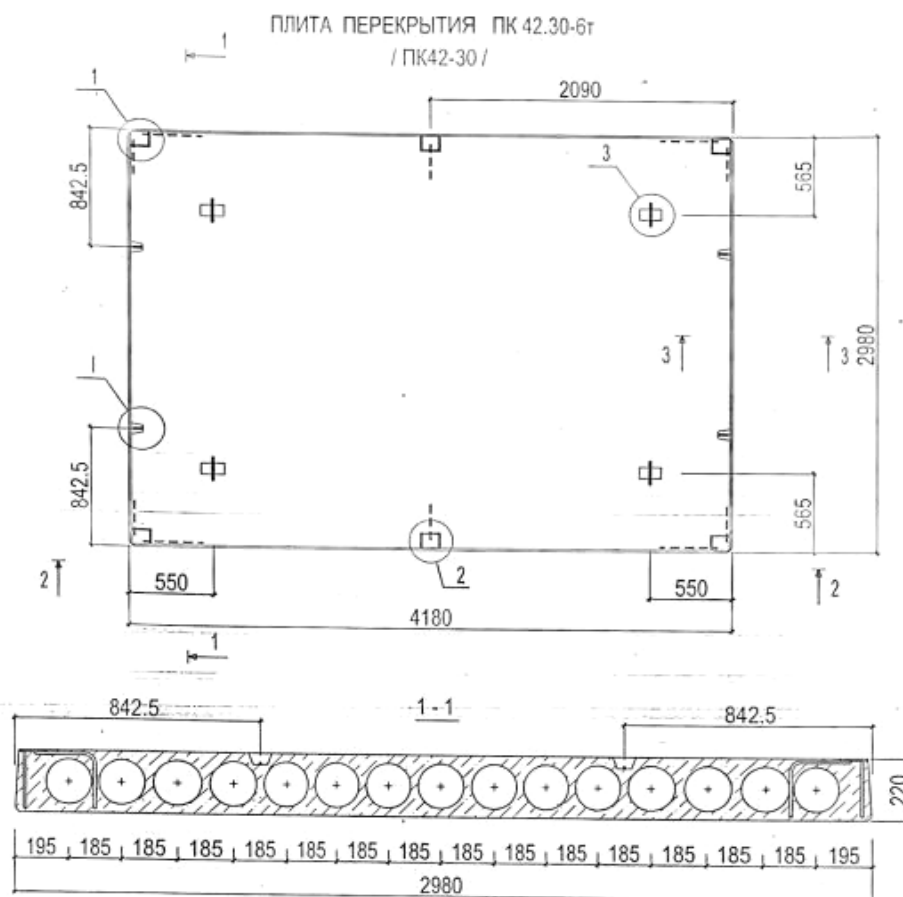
Многопустотная плита перекрытия ПК 42.30-6т серии 1.090.1-1/88 «Тольяттинская»
